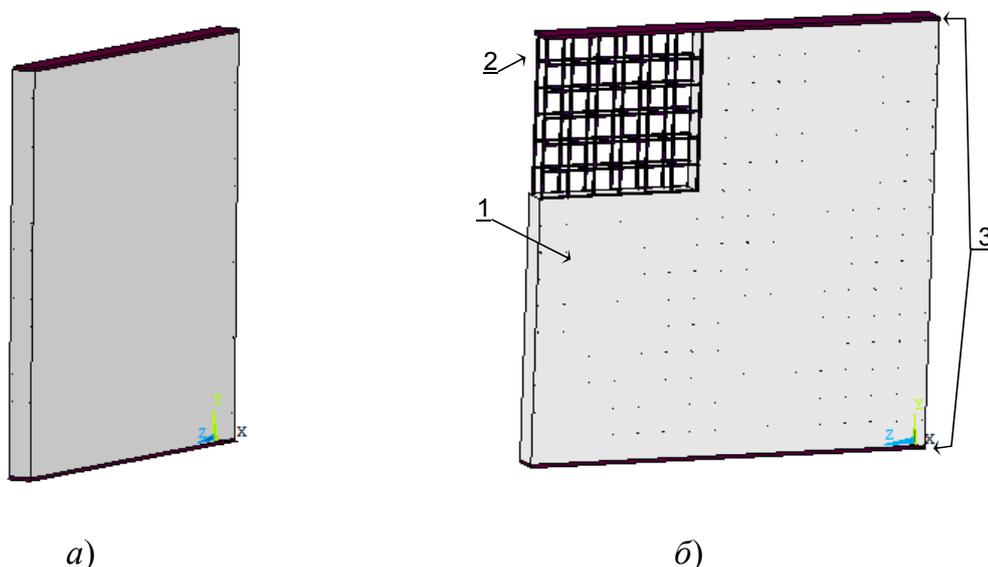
Схема расчетной области железобетонной несущей стены для проведения расчета предела огнестойкости: а – общий вид, который используют для вычислительного эксперимента; б – схема армирования: 1 – бетон; 2 – рабочий арматурный каркас: $d = 16$ мм; 3 – траверсы нагрузочной рамы
